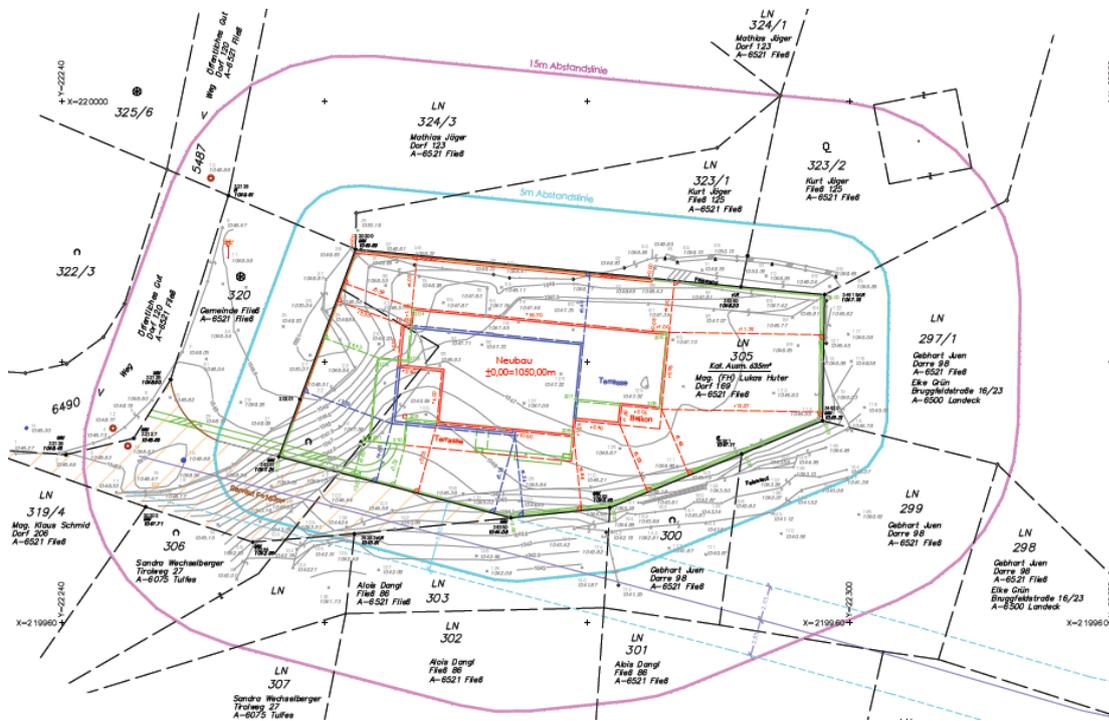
Lageplan des geplanten Wohngebäudes auf der neu vermessenen Gp. 305 laut Lageplan des Vermessungsbüros Stürz (ohne Maßstab)
